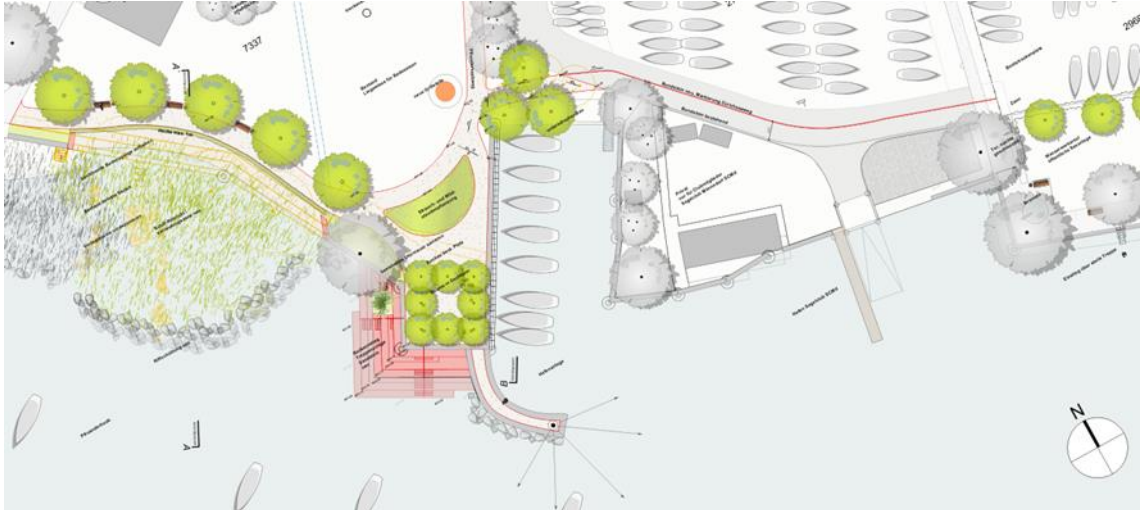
Planausschnitt Bereich Jugendhaus.
